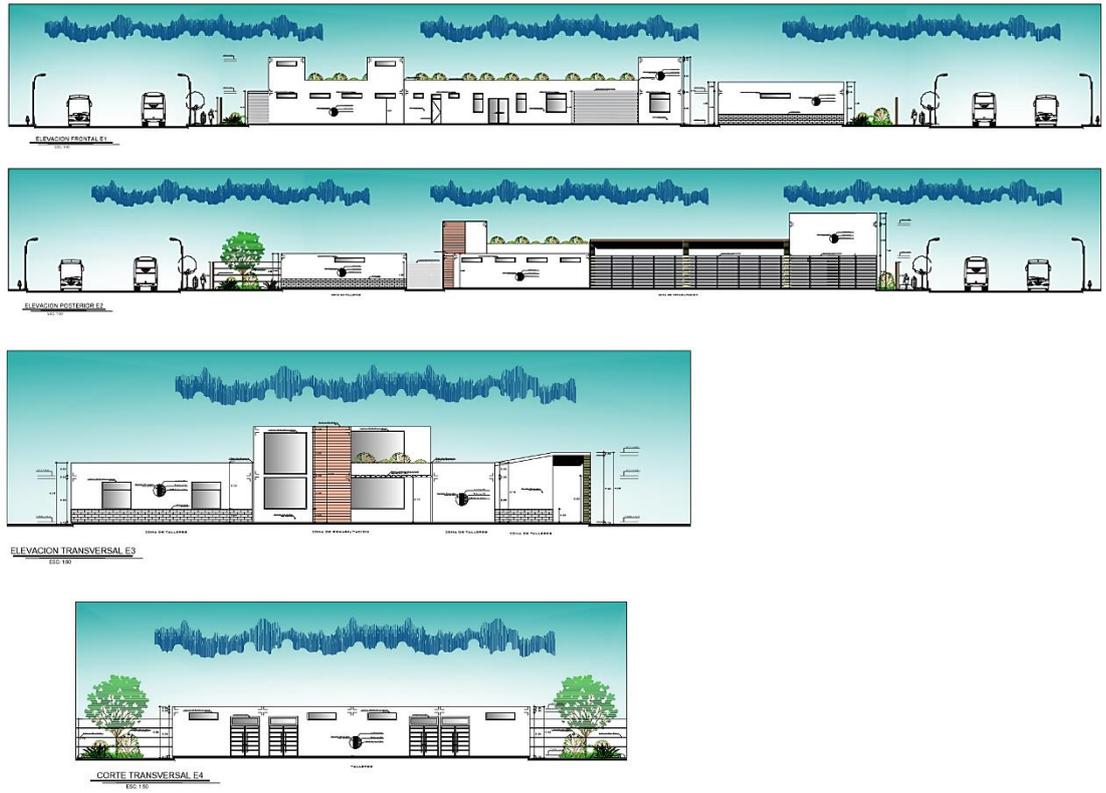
Elevaciones Longitudinales y Laterales Proyecto
